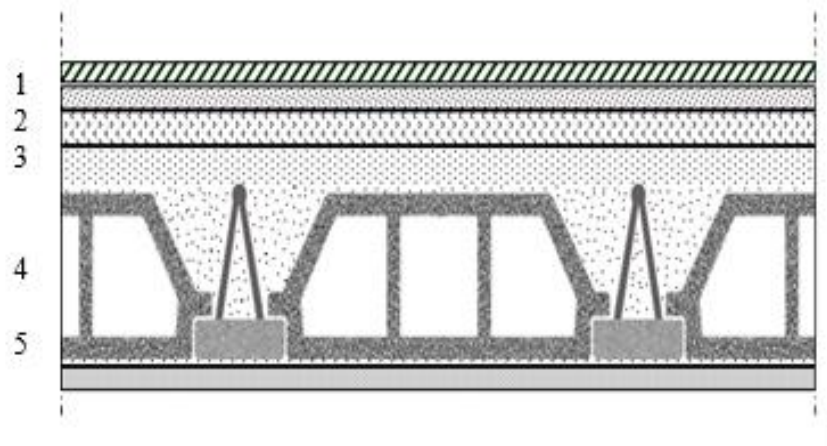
Coupe verticale du plancher courant à corps creux.
